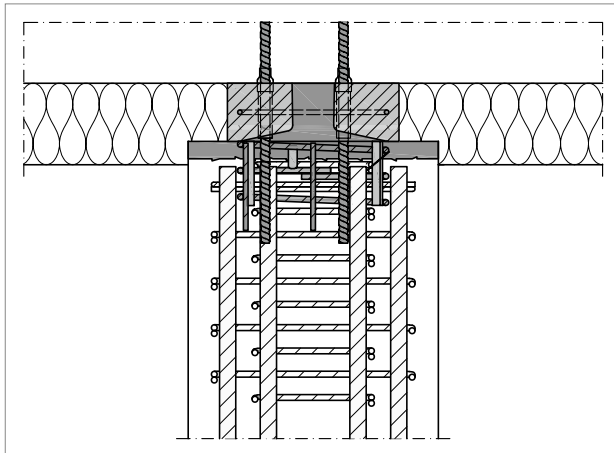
Schöck Sconnex® Typ P-O: Bewehrungsführung im Bereich 3 – Stützenlängsschnitt (gilt auch für Typ P-U)
